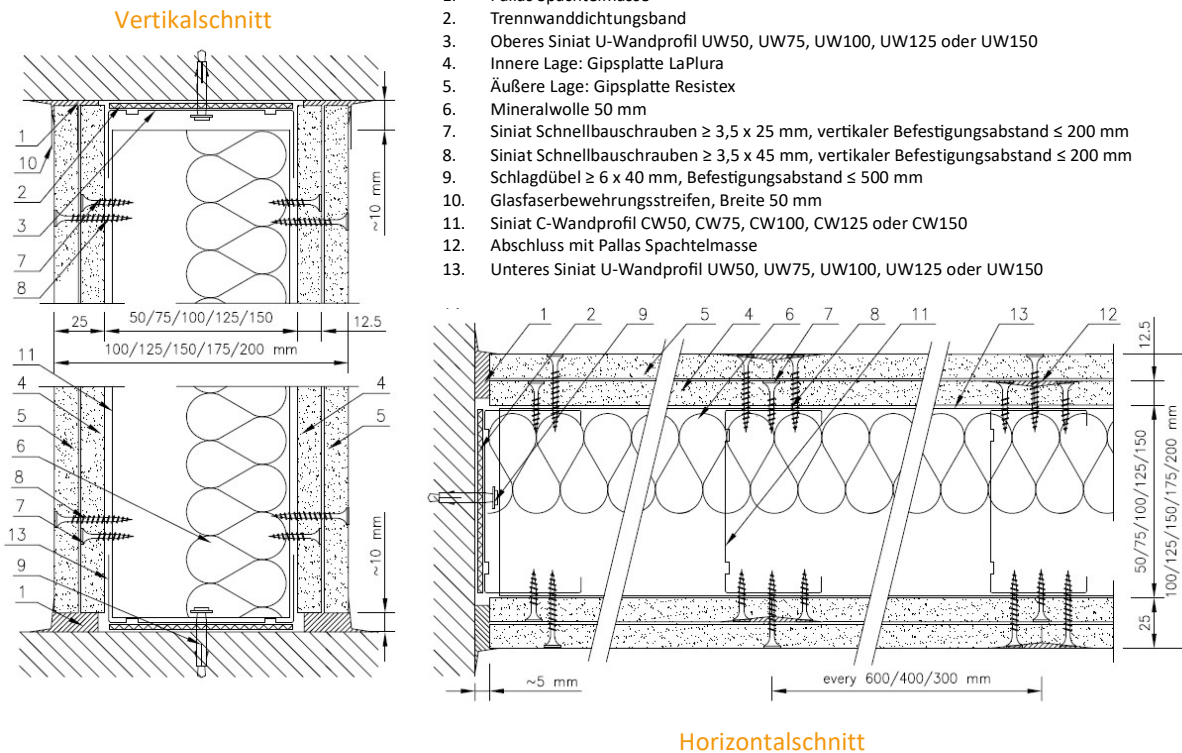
Vertikal- und Horizontalschnitt einbruchhemmender nichttragender zweilagig beplankter Einfachständerwände
